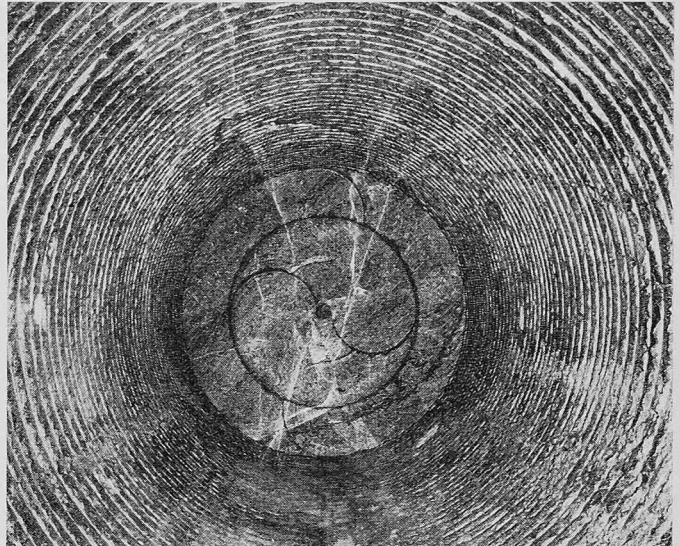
Stollenbrust im Malmkalk, Durchmesser 3,60 m
